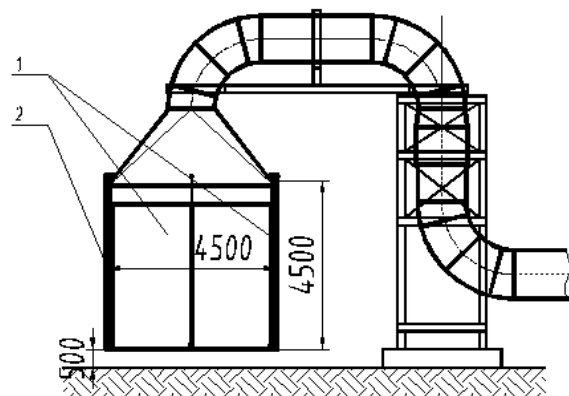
Поворотный зонт: 1 – подвижные шторы; 2 – неподвижная штора
